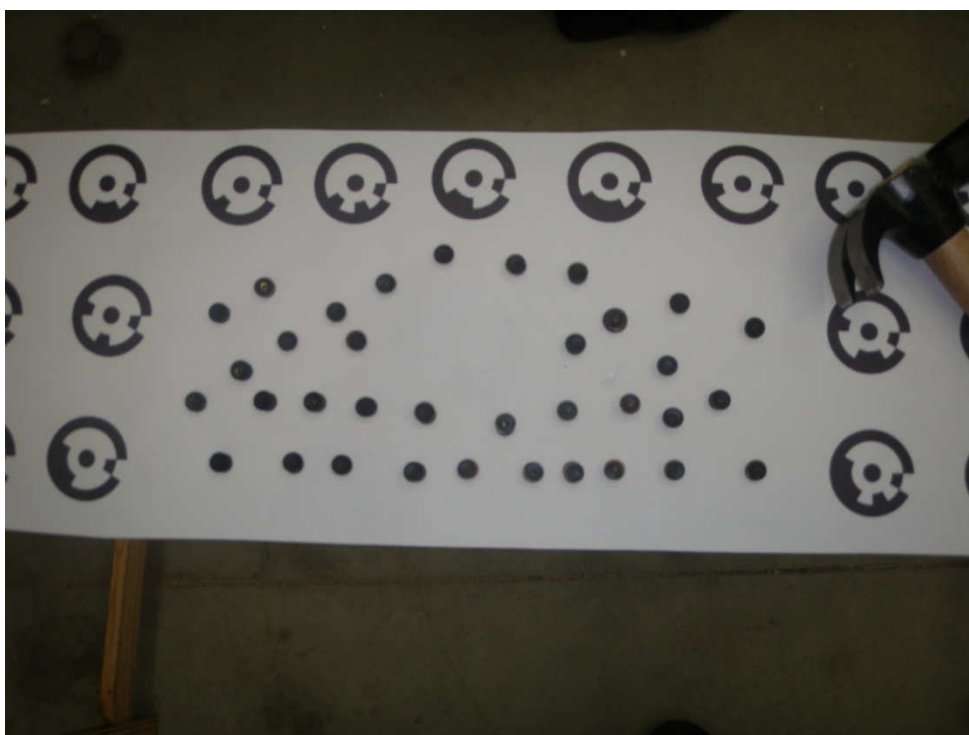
Colocación de las chinchetas en las vigas (E.P.)
